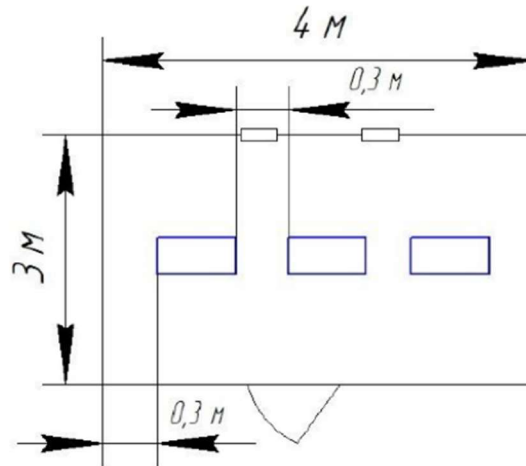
План помещения и размещения светильников с люминесцентными лампами.
